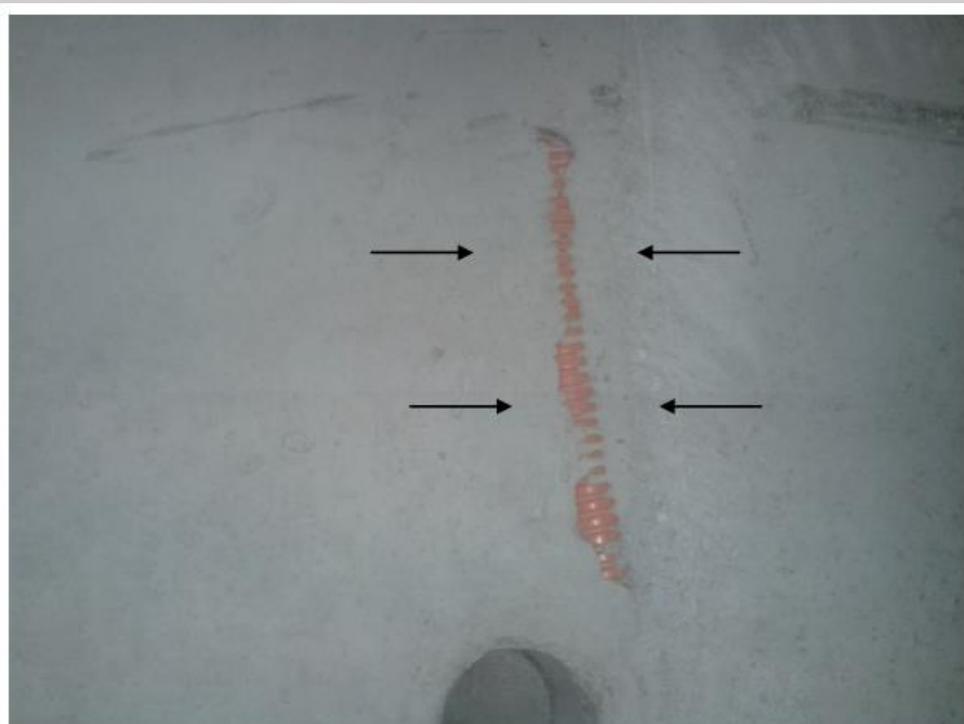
Falha cobertura: Eletroduto aparente na superfície concreto
